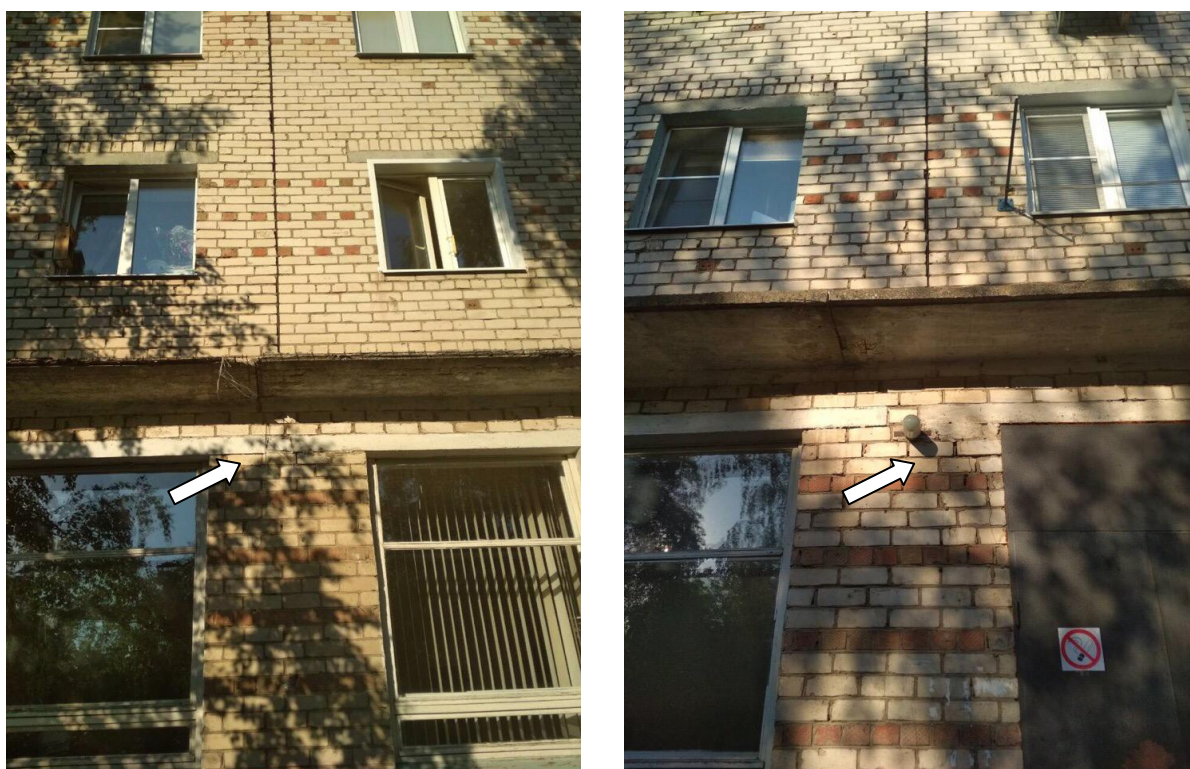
трещина в кирпичной стене первого этажа под деформационным швом, выполненным только выше перекрытия первого этажа (г.Тольятти, ул. Жилина, дом 56)
